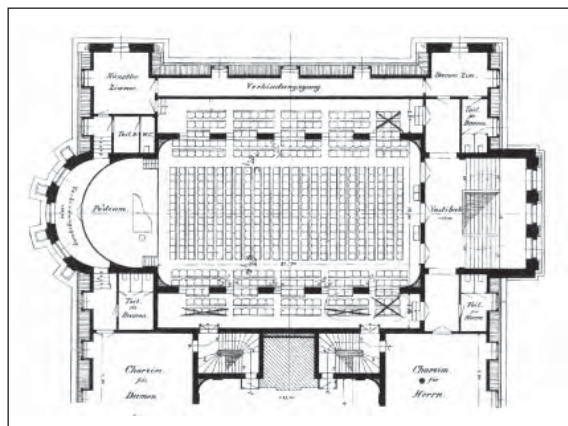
Laeishalle, Kleiner Saal, Grundriss, Ausführter Entwurf von M. Haller vom 21. 3. 1908 Mit Korrekturen
